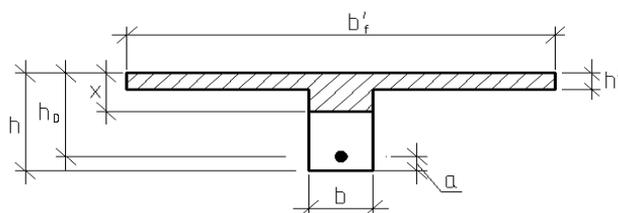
2 случай положения границы сжатой зоны бетона в элементах таврового профиля
